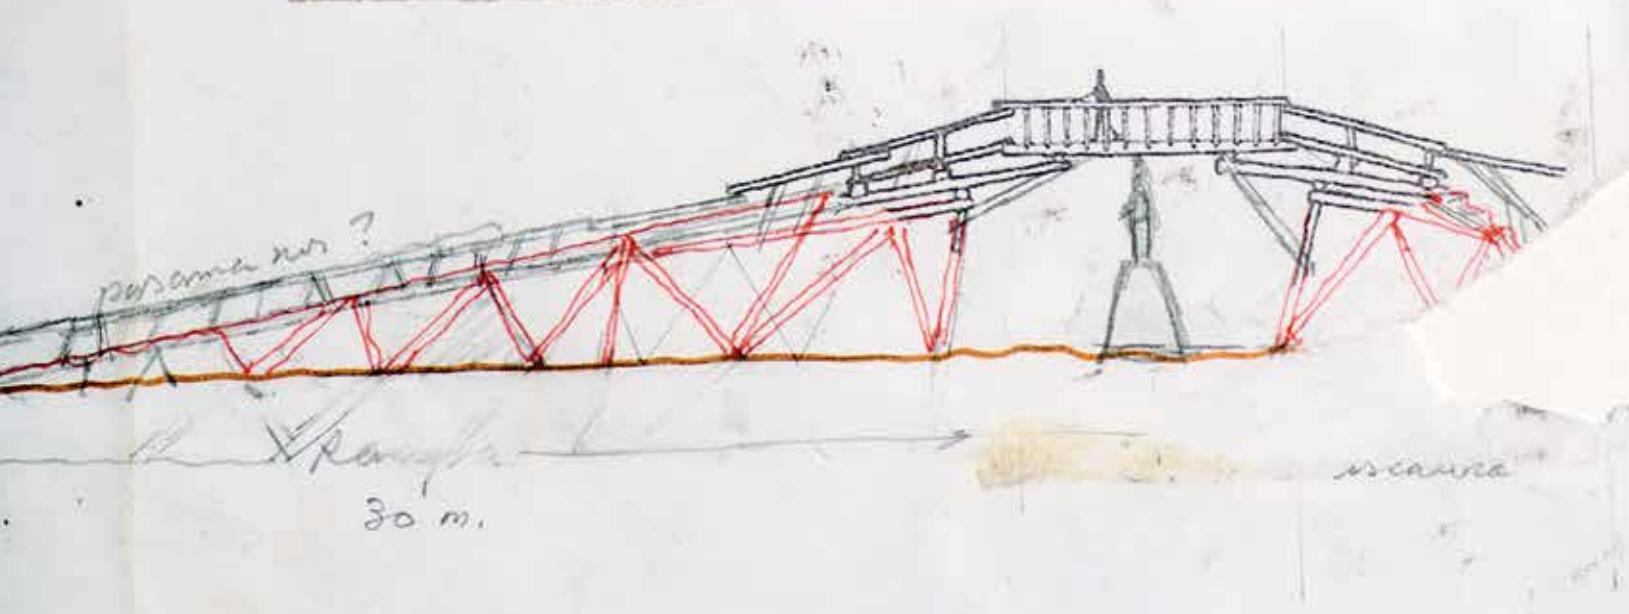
Puente de madera en cantilever Dugh Kosi, Nepal. Un extremo de las vias de madera en cantilever esté encorvado bajo la pieza final en cantilever sostiene el espacio central.
